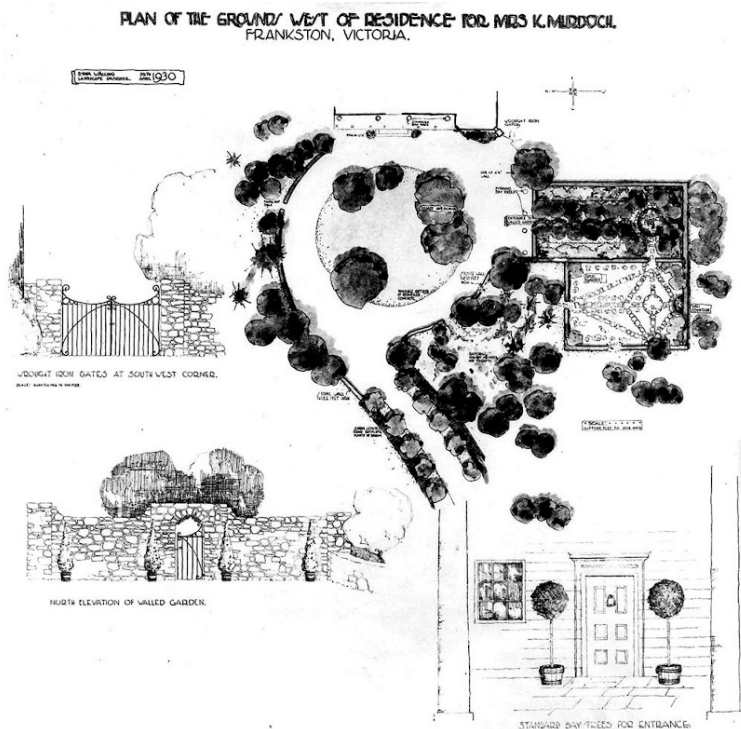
Progetto e pianta per Mrs K. Murdoch., Edna Walling, 1930.
